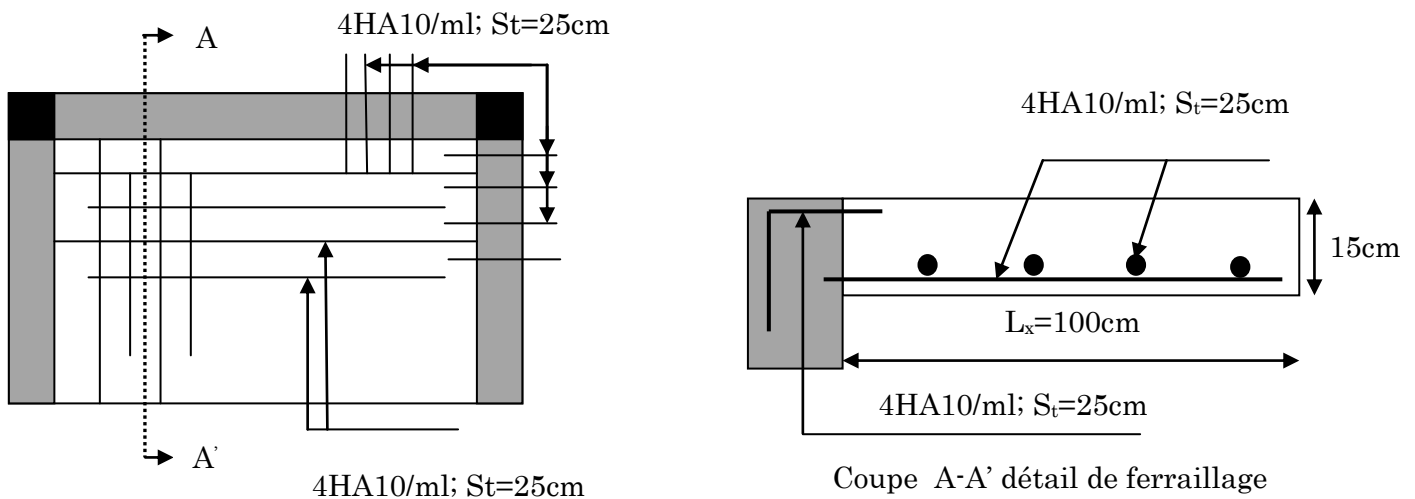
Schéma de ferrailage –dalle sur trois appuis
